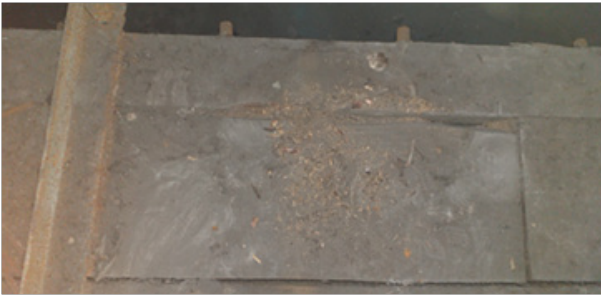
Зазор между стыками элементов нижней фермы (уменьшение сечения элемента)
